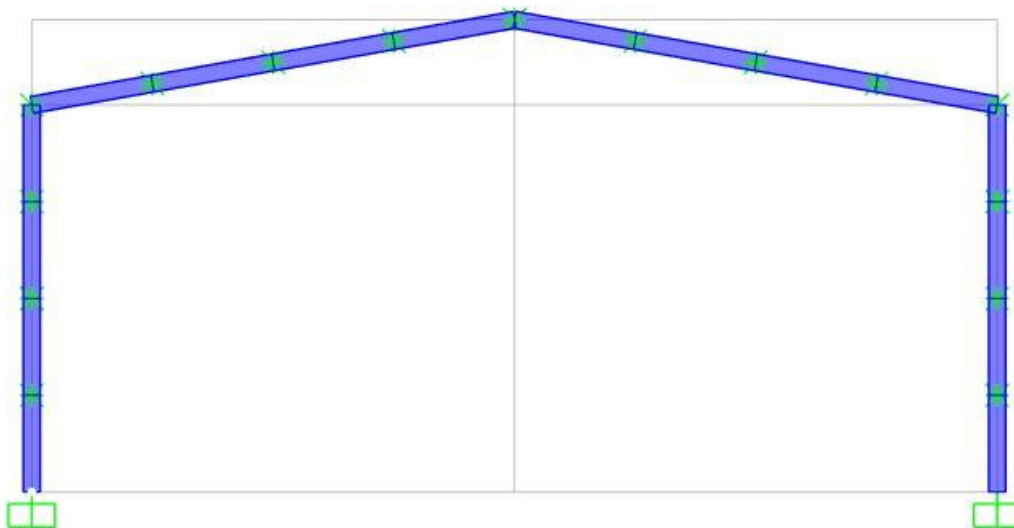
Pórtico extruido con barras divididas y apoyos intermedios.
